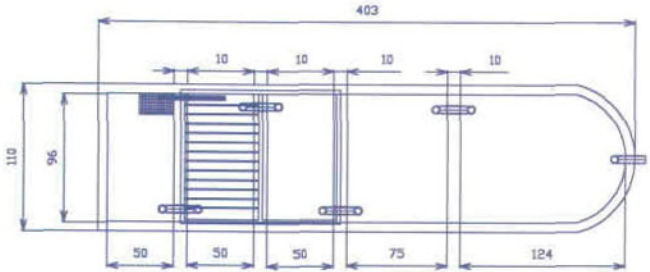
Vista en planta del lavadero ecológico (medidas en cm).
